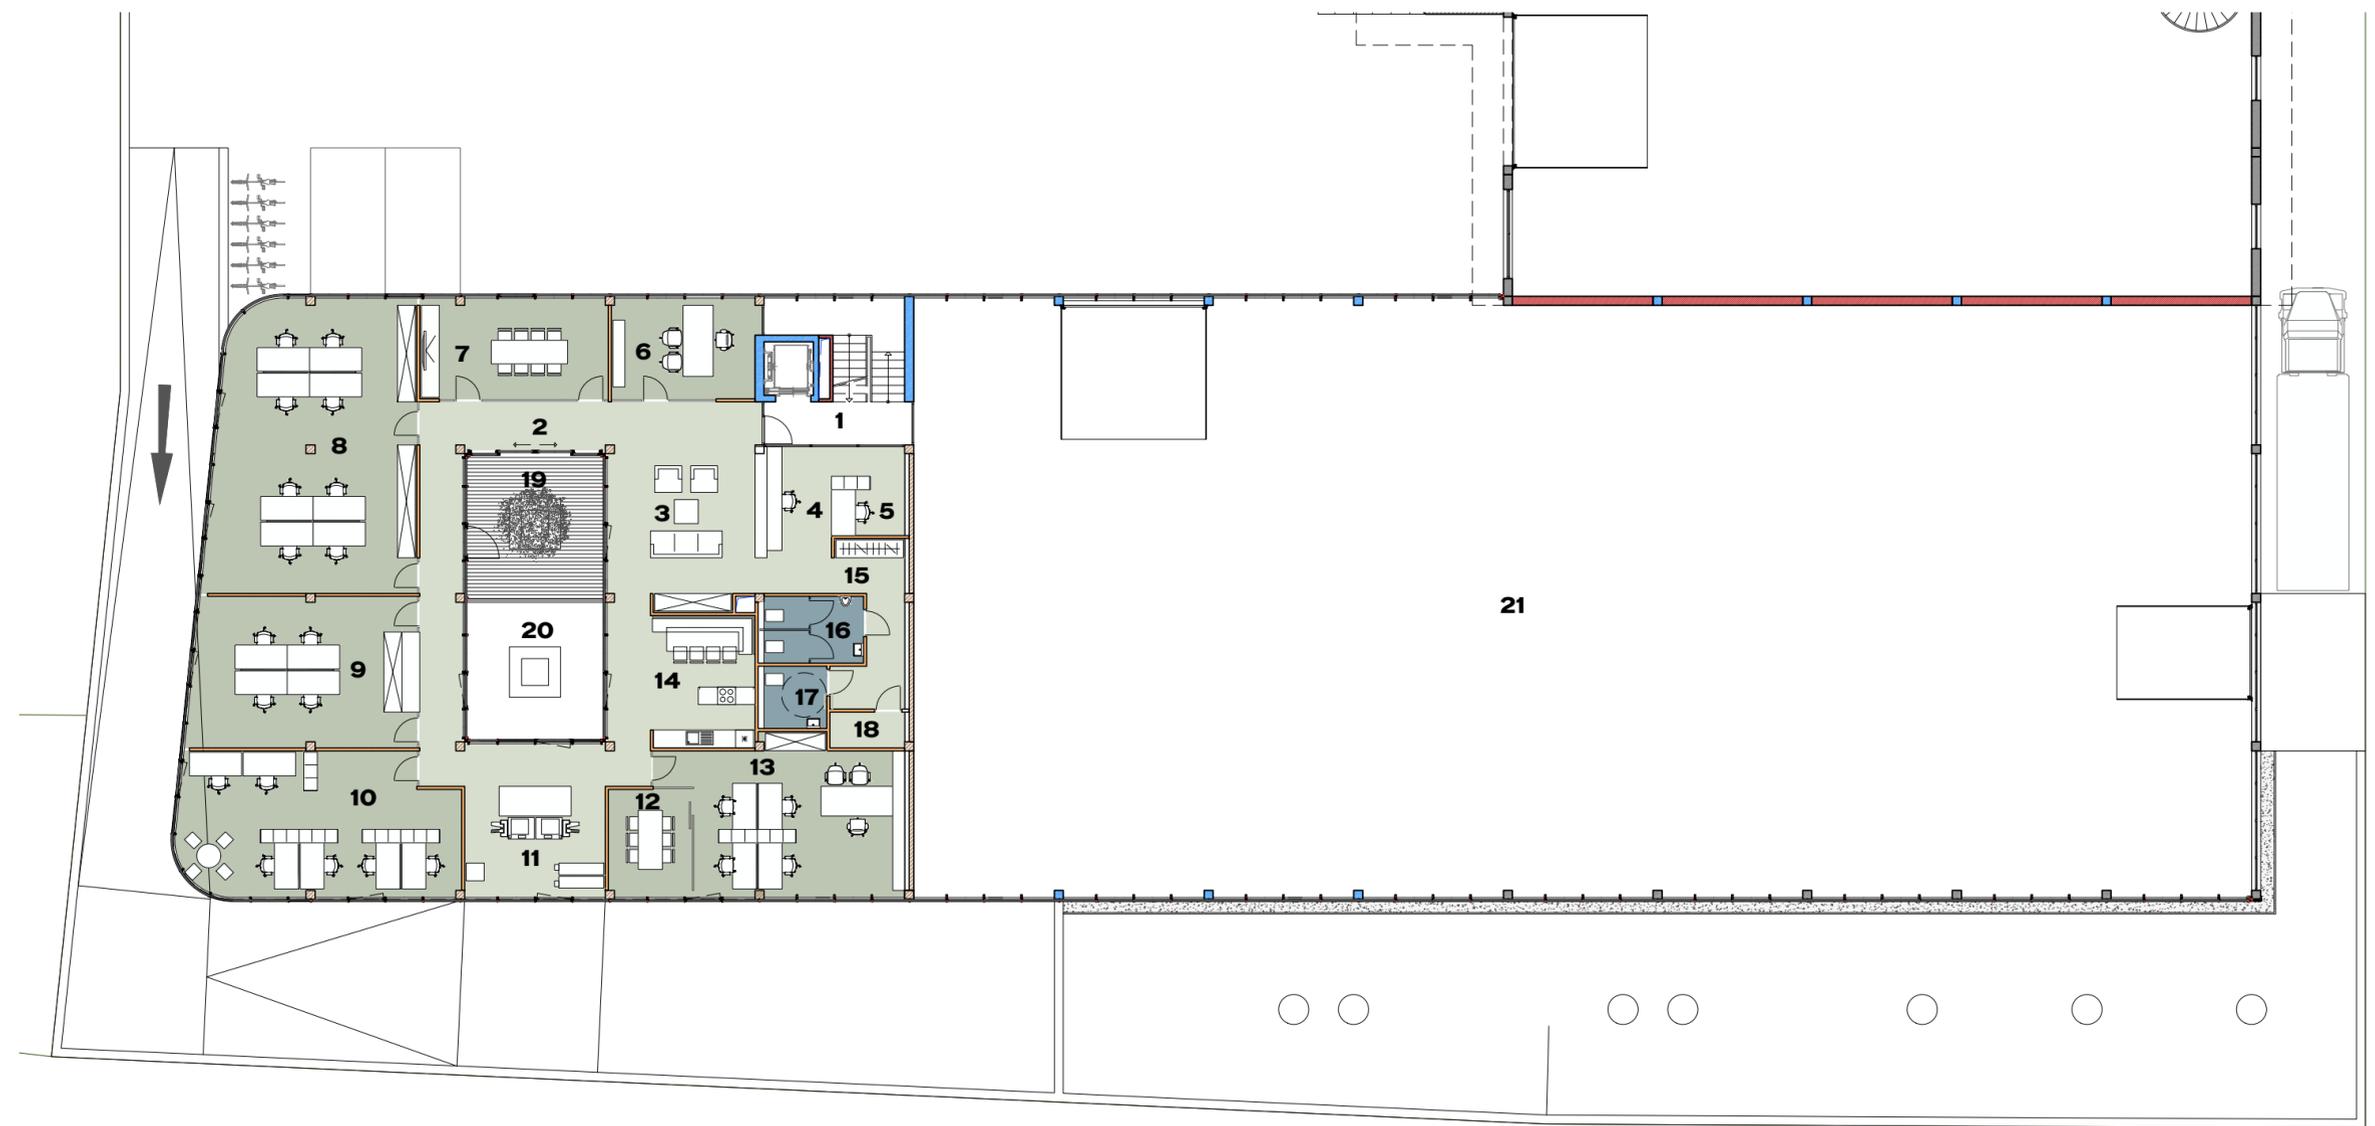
Entwurf - Erdgeschoß Neubau - Bauphase 2
